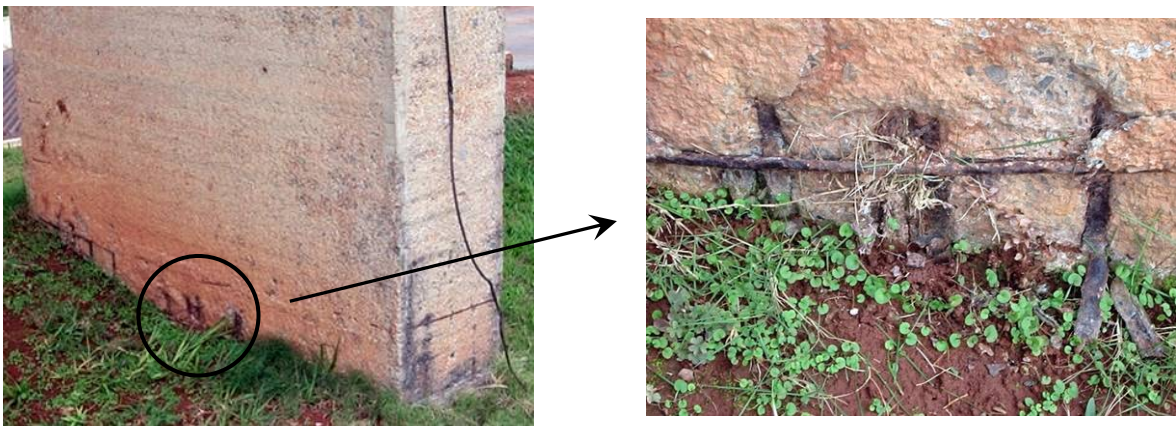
Pilar P80, corrosão acentuada na armadura principal e estribos
